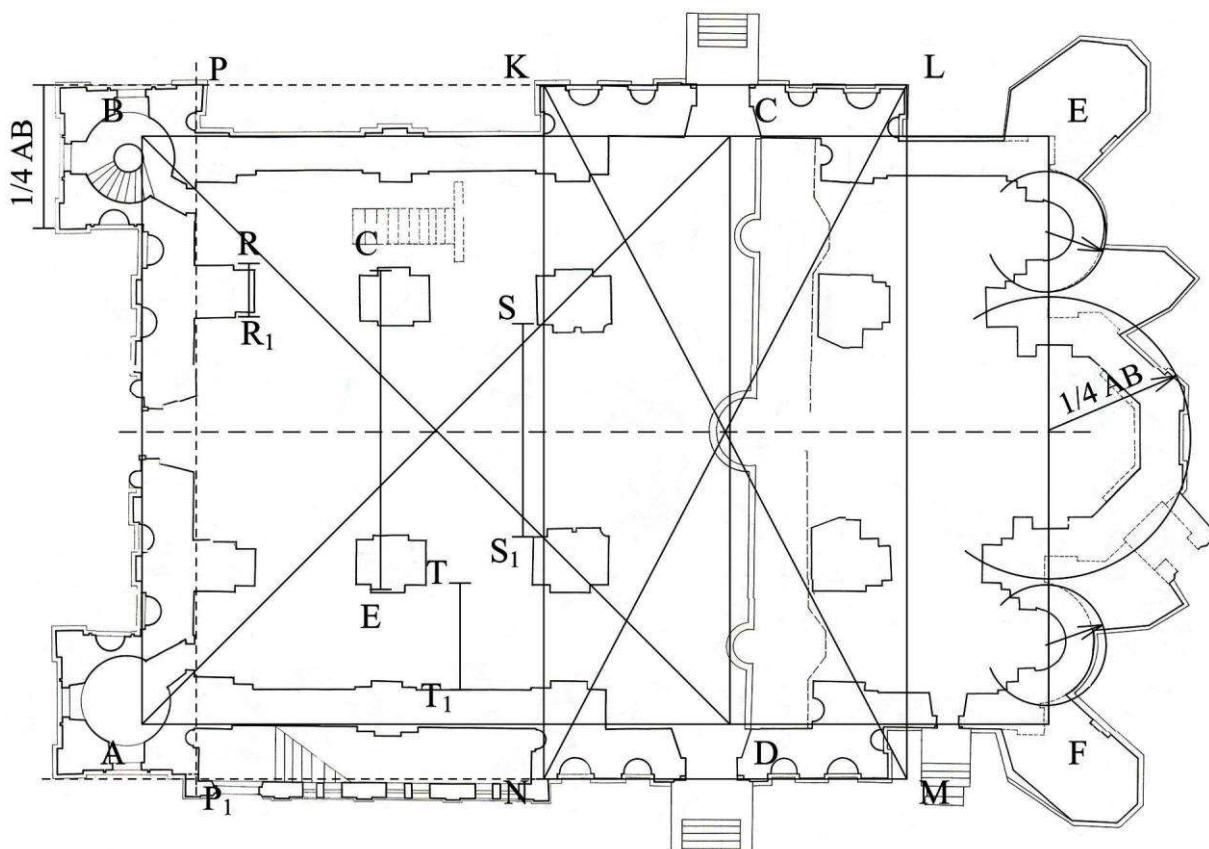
(продовження). Схема побудови плану Троїцького собору
